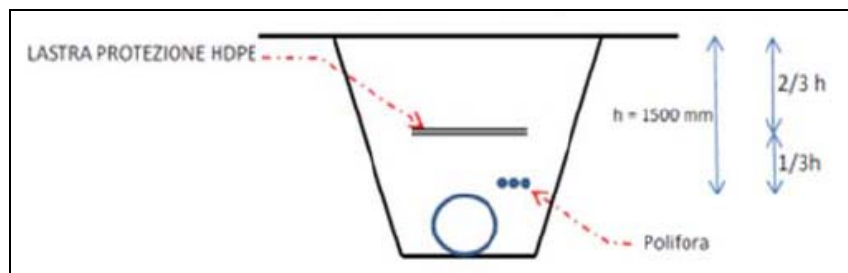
/B – Schema della sezione di scavo con indicata la posizione delle piastre in HDPE
